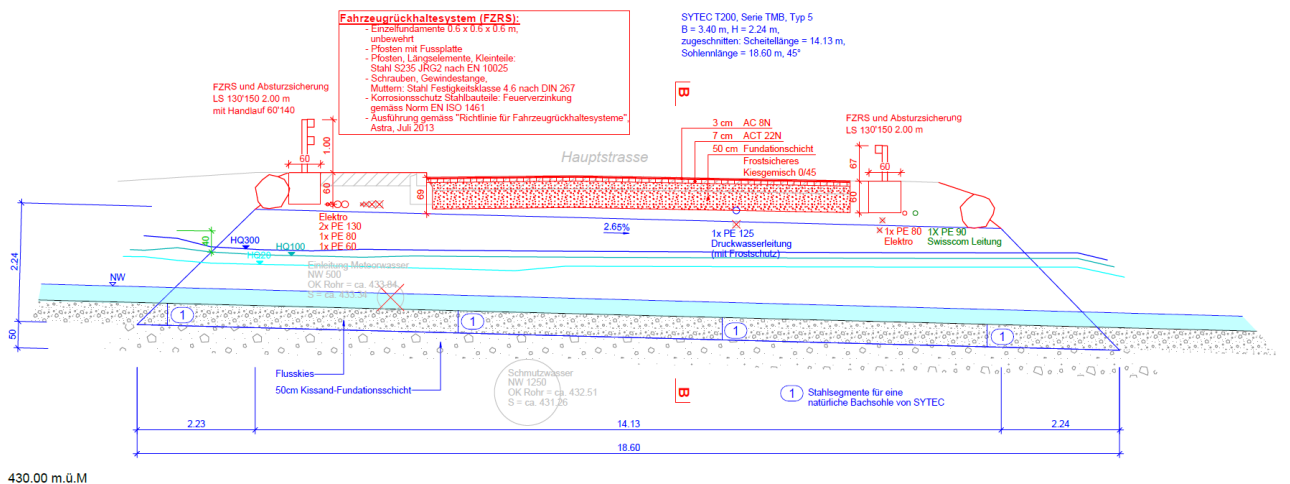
Schnitt A-A Durchlass (Detailplan Durchlass Hauptstrasse, Plan-Nr. 6.285/33.541 A, Beilage 2.9, Stand 21.10.2016).
